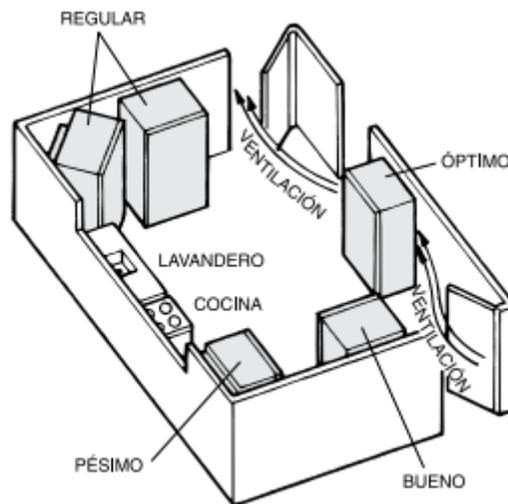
Sugerencia para la colocación de un sistema de refrigeración.
